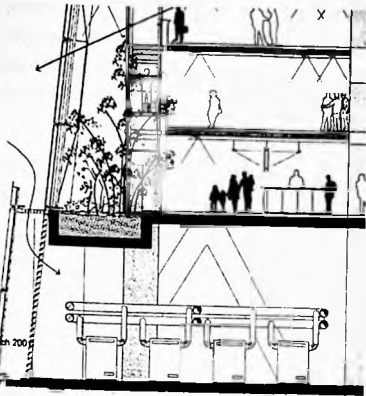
Corte de pavimentos de escritório com as áreas de jardim junto as fachadas. Fonte: imagem cedida por Renzo Piano Building Workshop.
